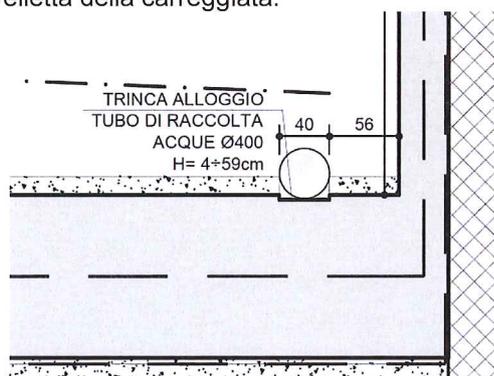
Esempio disposizione tubo di raccolta acque di piattaforma
